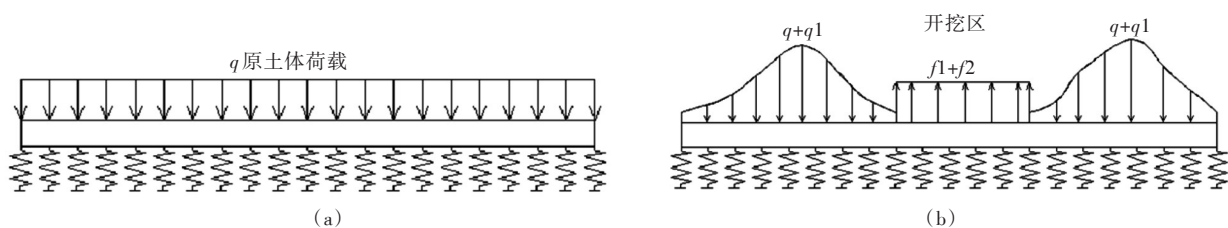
施工前后既有隧道受力示意图 (a) 施工前既有隧道受力示意图;(b) 上跨隧道施工后既有隧道受力示意图
